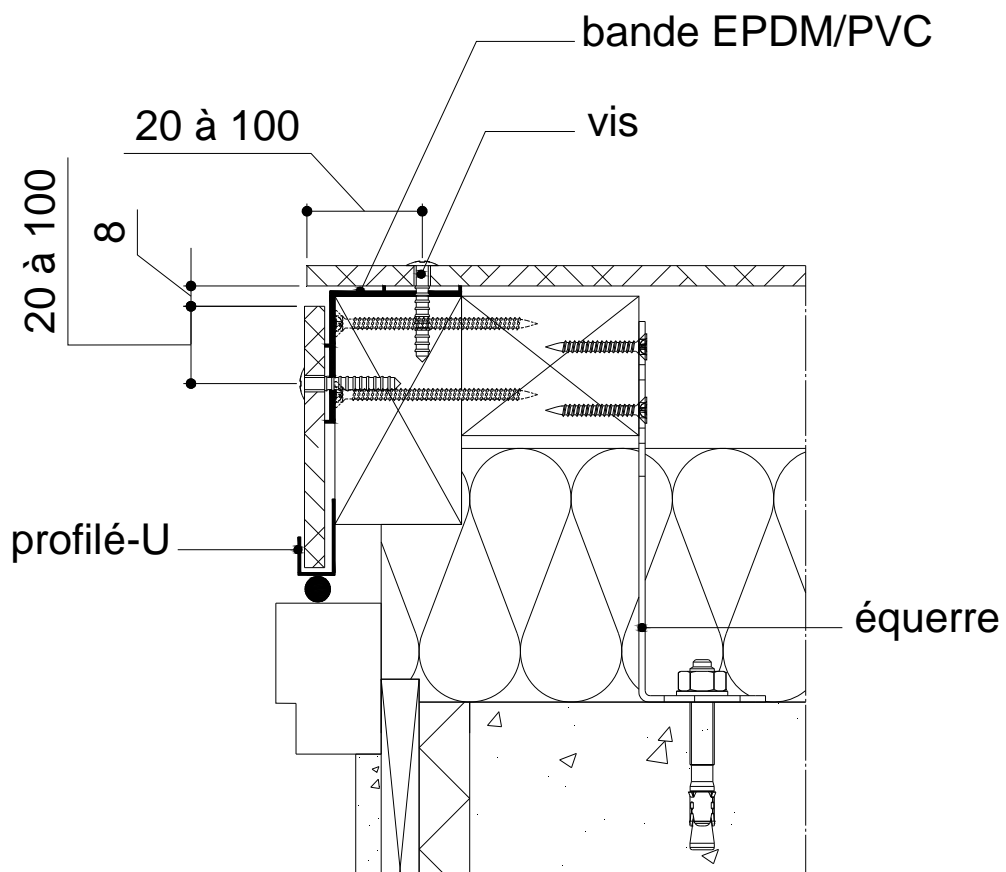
Détail tableau sur ossature bois (cote en mm)
